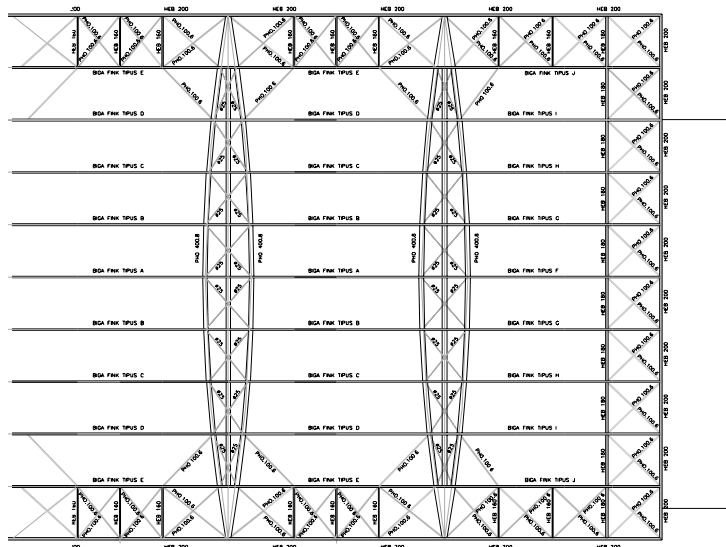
Detall Planta Coberta. | *Detalle Planta Cubierta.
